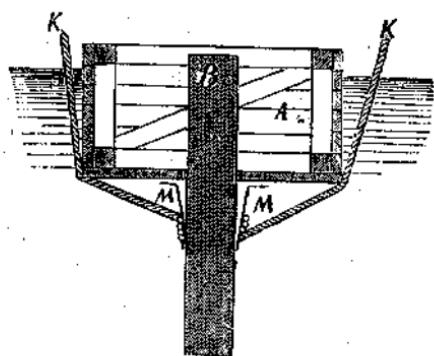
Приспособленіе для варубанія шиновъ на сваѣ: А—ящикъ; В—свая;
